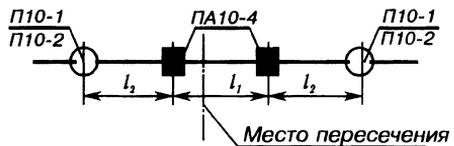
Размещение оттяжек на переходной опоре ПА10-4
